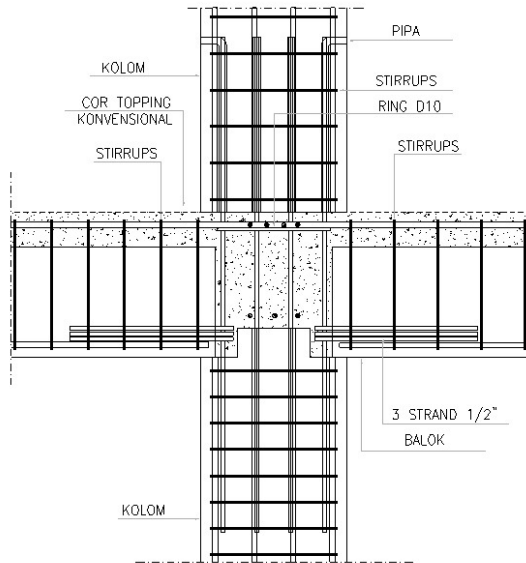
Detail Kolom dan Pertemuan Balok-Kolom di Tepi pada Struktur Pracetak JEEDS
